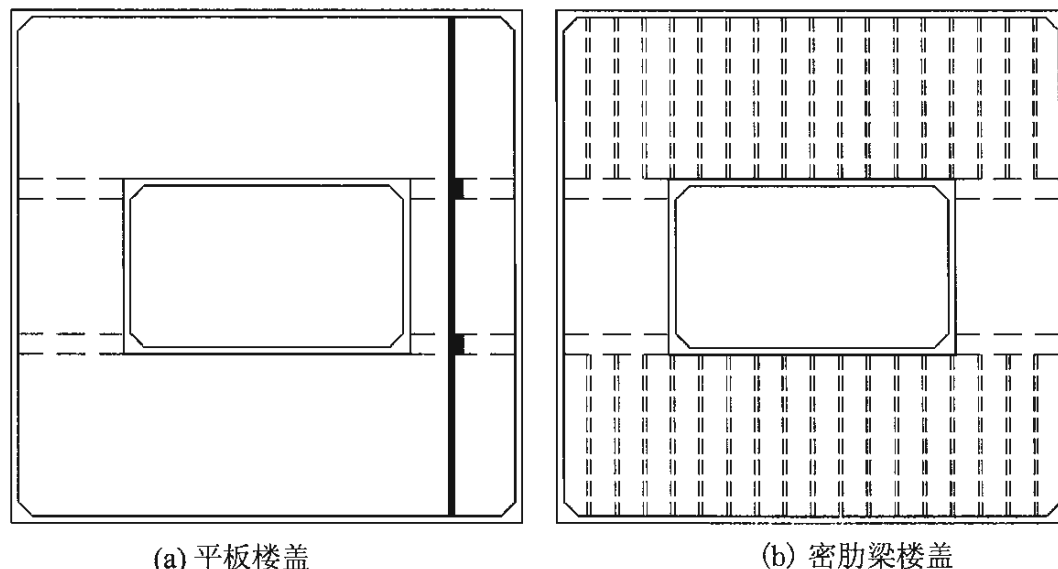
筒中筒结构体系预应力混凝土楼盖
